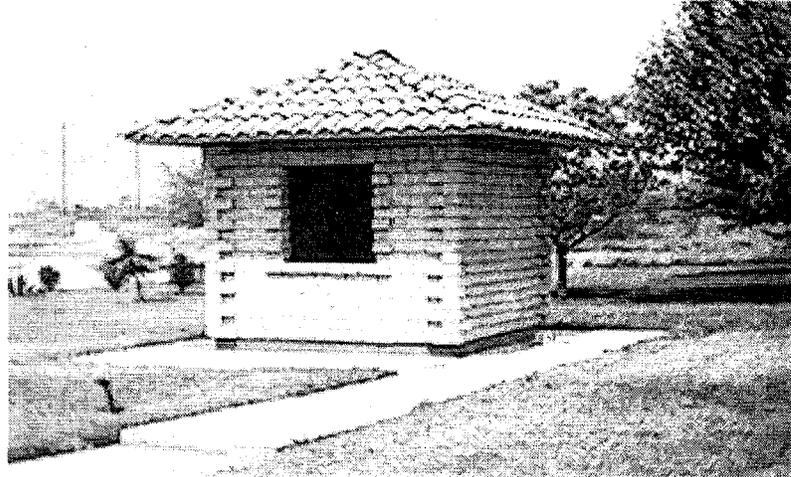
Foto de caseta de vigilancia construída con ladrillos de la planta piloto
